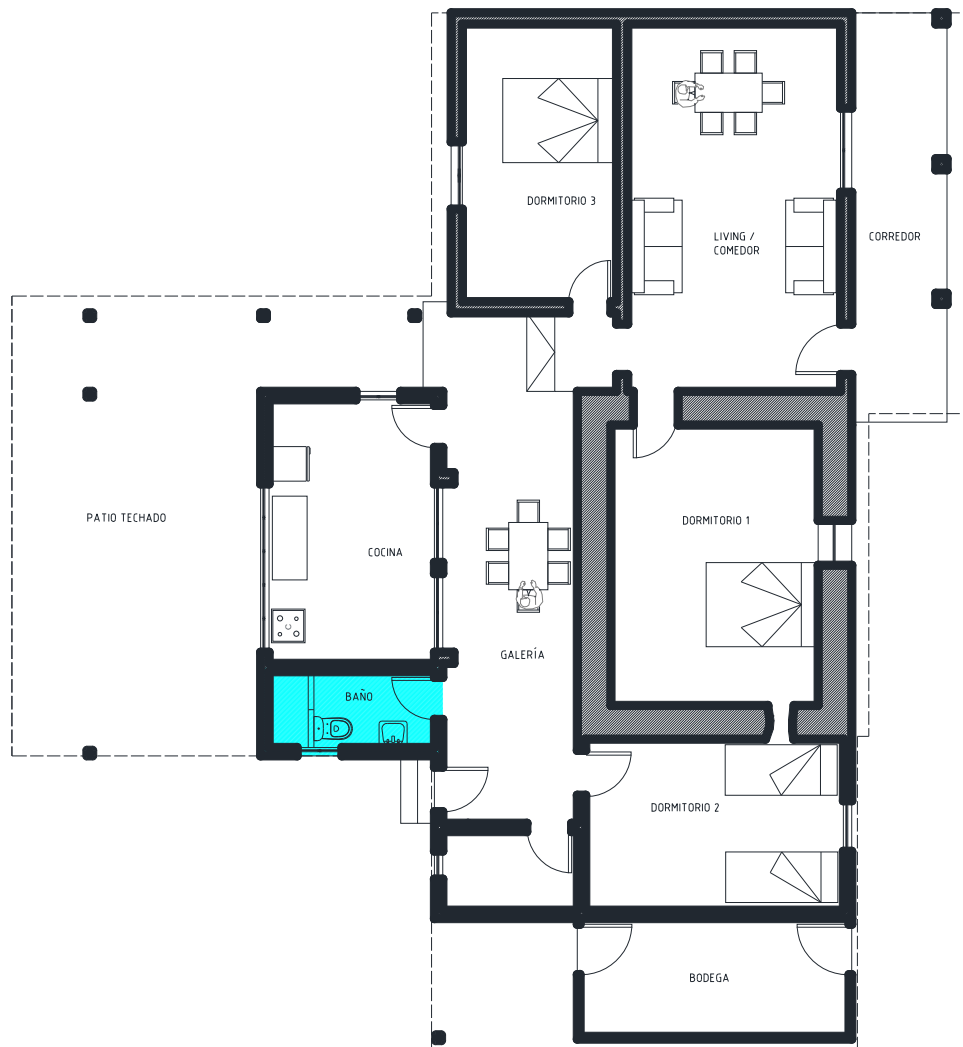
Planta de la casa de una de las entrevistadas, antes de su reconstrucción, mostrando con cian el recinto de baño.
